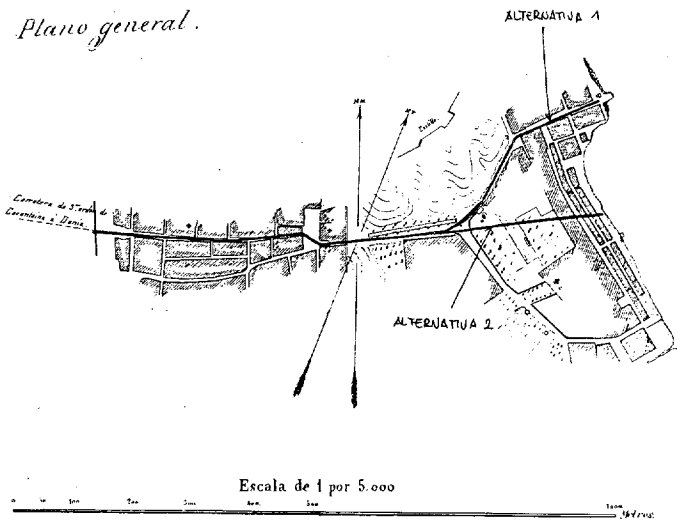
y 3.—En la figura 2 se ha marcado en grueso las dos alternativas propuestas de travesía de la carretera Cocentaina-Denia que debía de llegar hasta el mismo puerto. Y en el plano de la figura 3 se aprecia la ciudad actual con el trazado elegido finalmente y el desarrollo del tejido urbano a lo largo de la travesía que se constituyó así en el eje de conexión y crecimiento entre el antiguo casco de la ciudad y el puerto.
